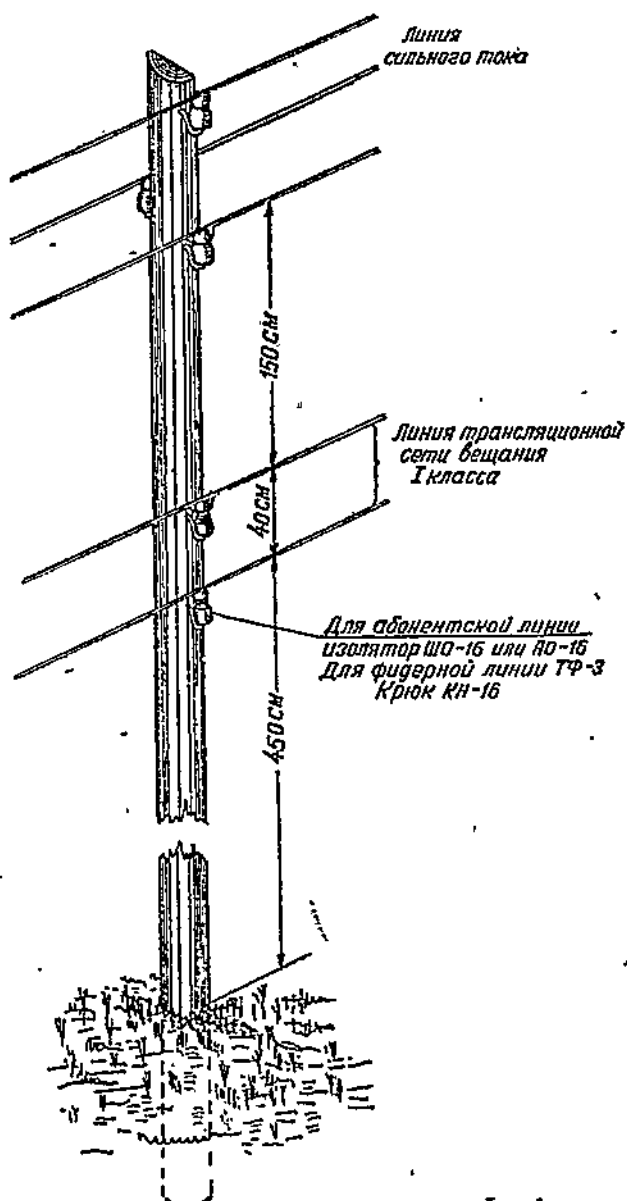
Подвеска проводов тсв на опорах электросети (на крюках).
